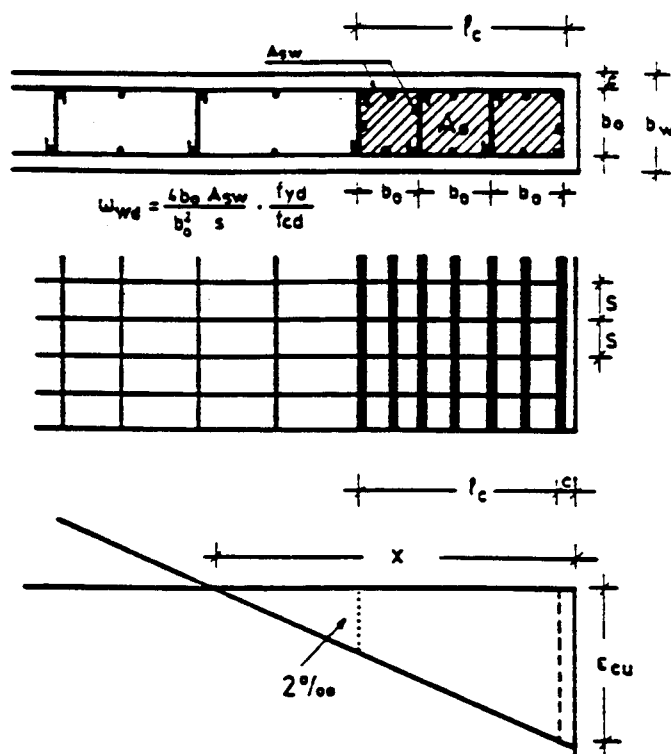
Umschnürtes Randelement einer Wand mit freien Rändern
